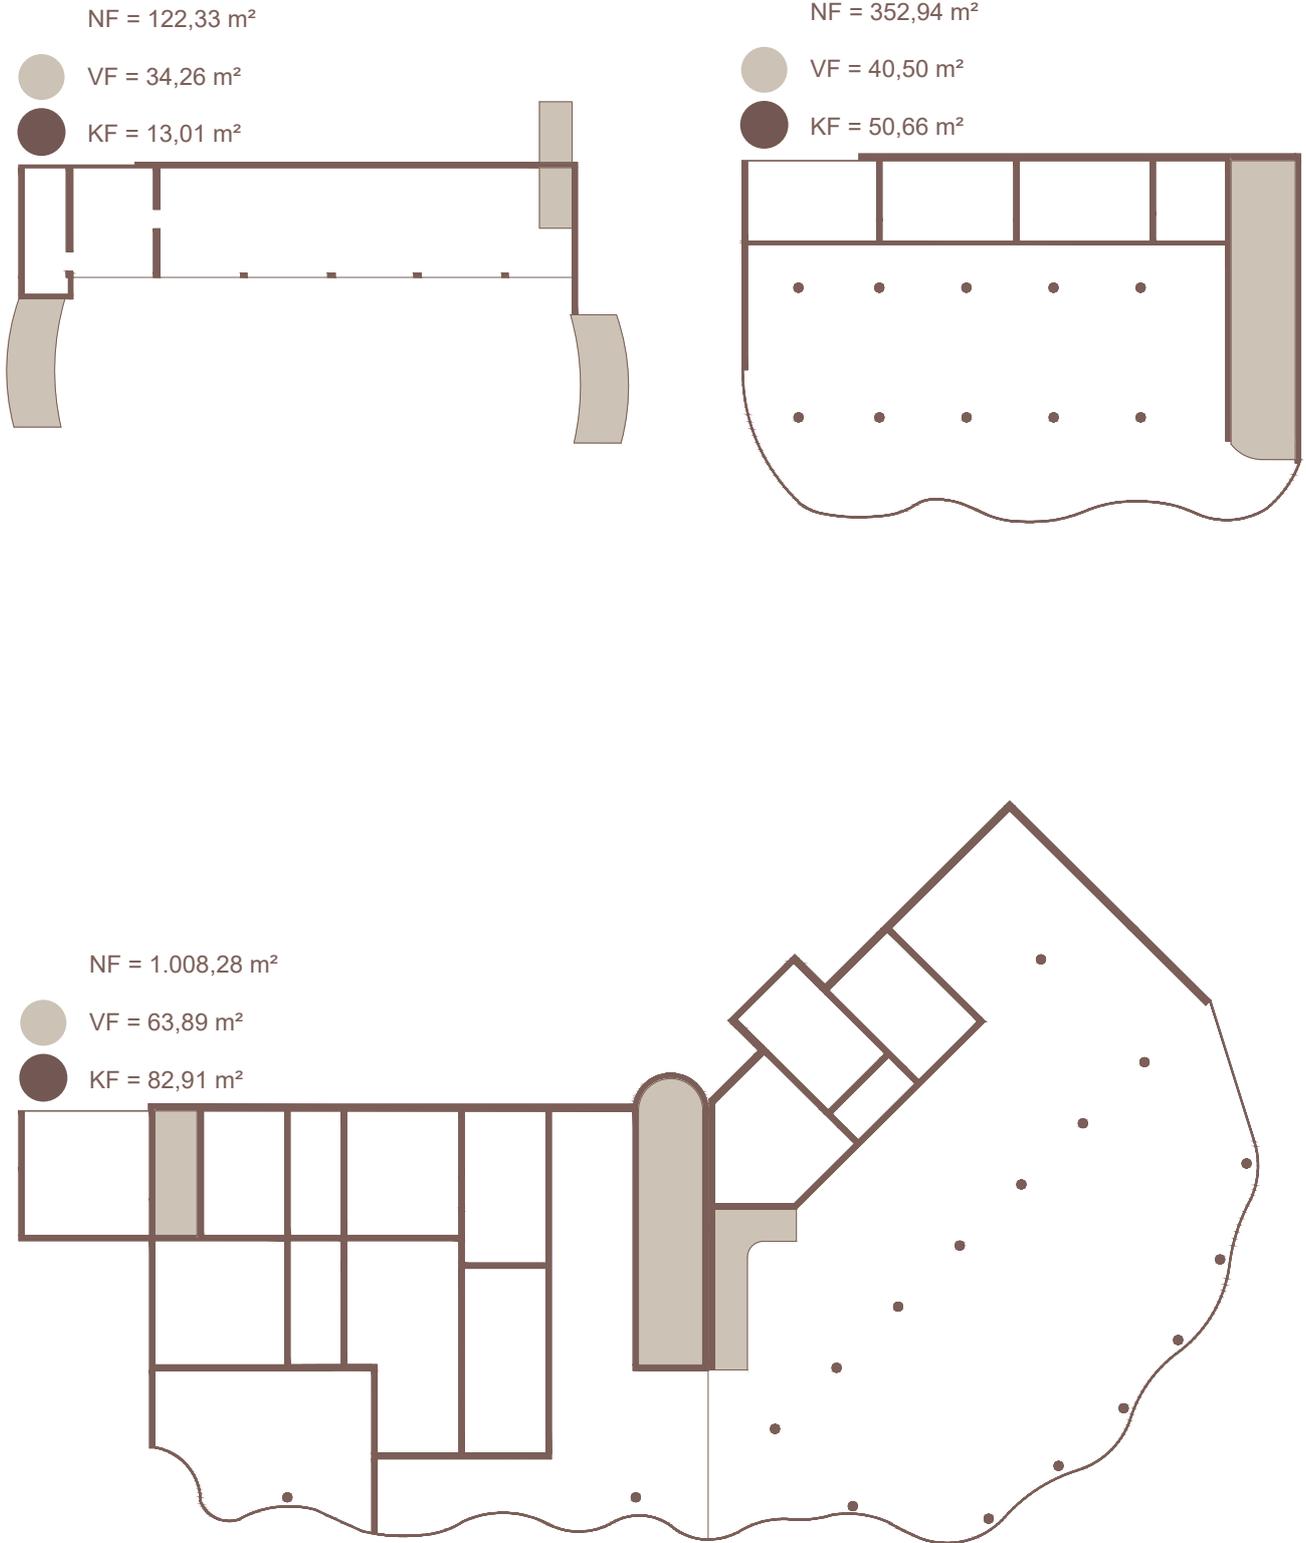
Flächenberechnung Zubau - 3., 2. und 1. Untergeschoss
